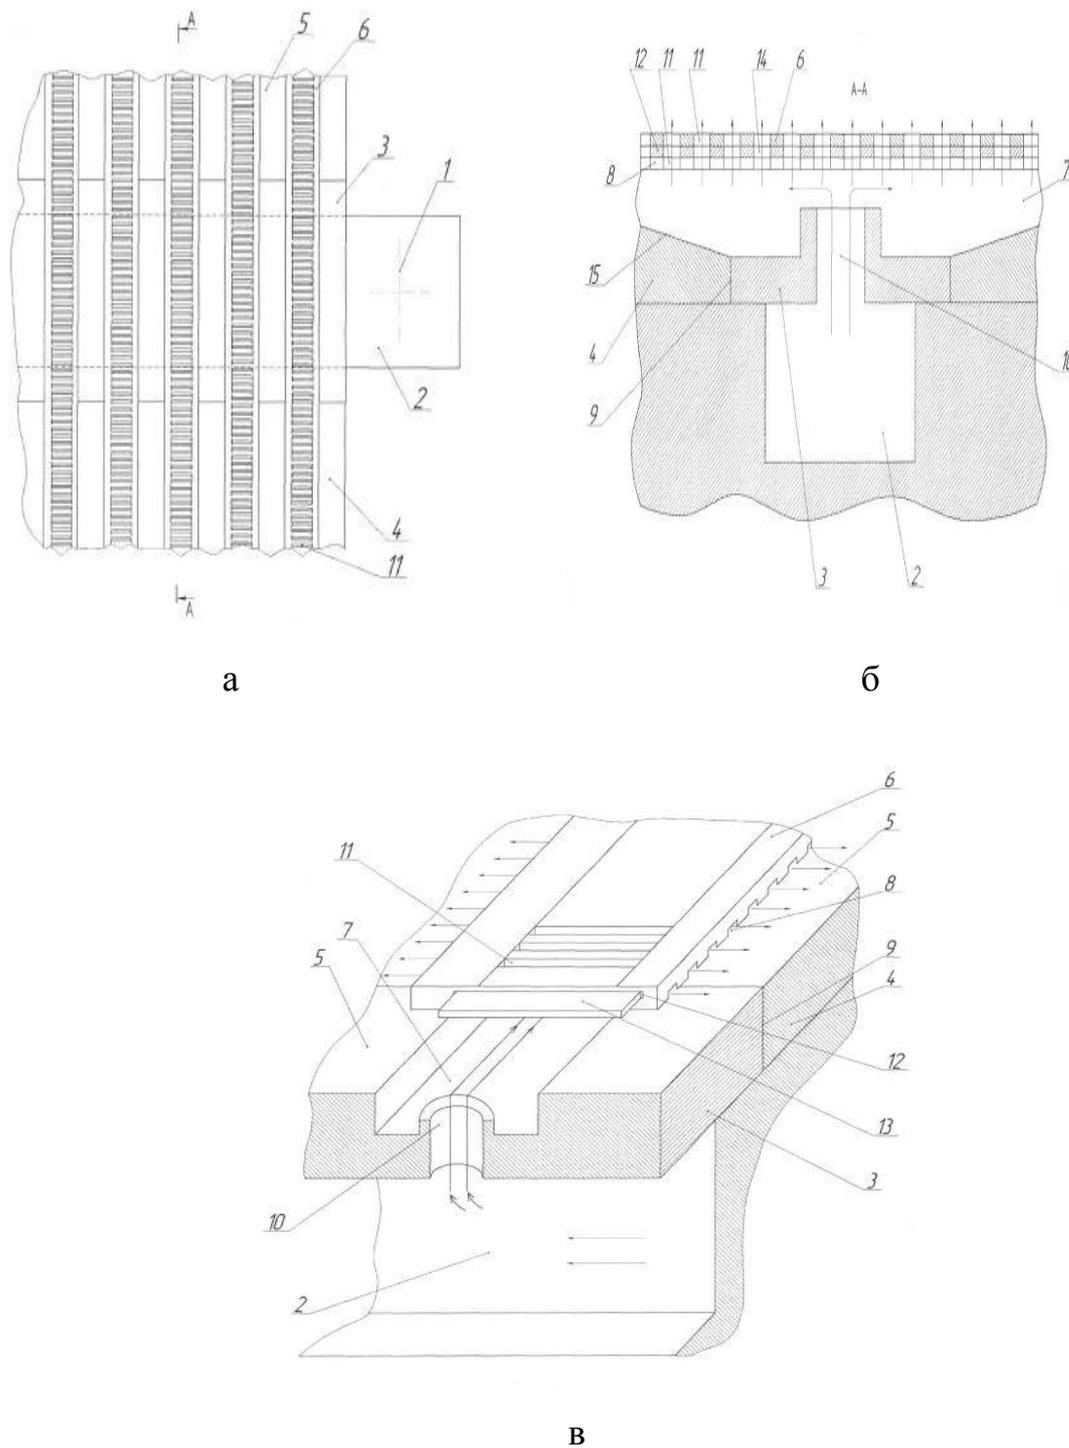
Общий вид устройства для охлаждения и сушки зерна активным вентилированием: 1 – источник вентиляции; 2 – канал, который располагается внутри пола; 3 – решетка; 4 – плиты; 5 – рифли; 6 – крышки; 7 – вентиляционный канал; 8 – поперечный пазы; 9 – соединительный материал; 10 – сквозные отверстия; 11,14 – щелевые отверстия; 12 – продольные пазы; 13 – подвижные пластины; 15 – нижняя поверхность.
